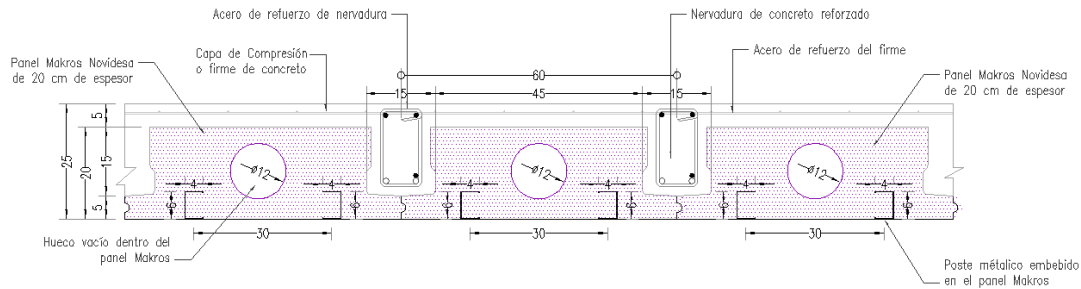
Sección transversal de panel de poliestireno con acero de refuerzo y concreto.
